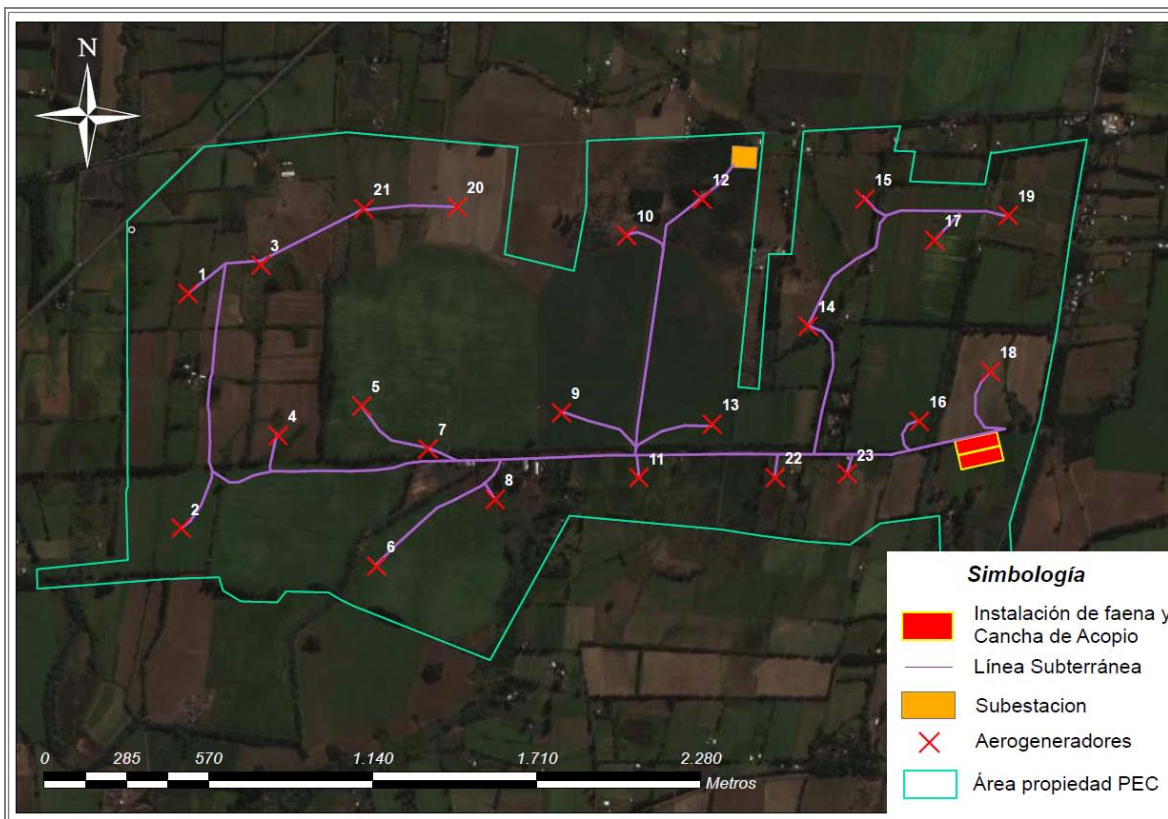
Emplazamiento de la instalación de faenas y canchas de acopio de materiales.
